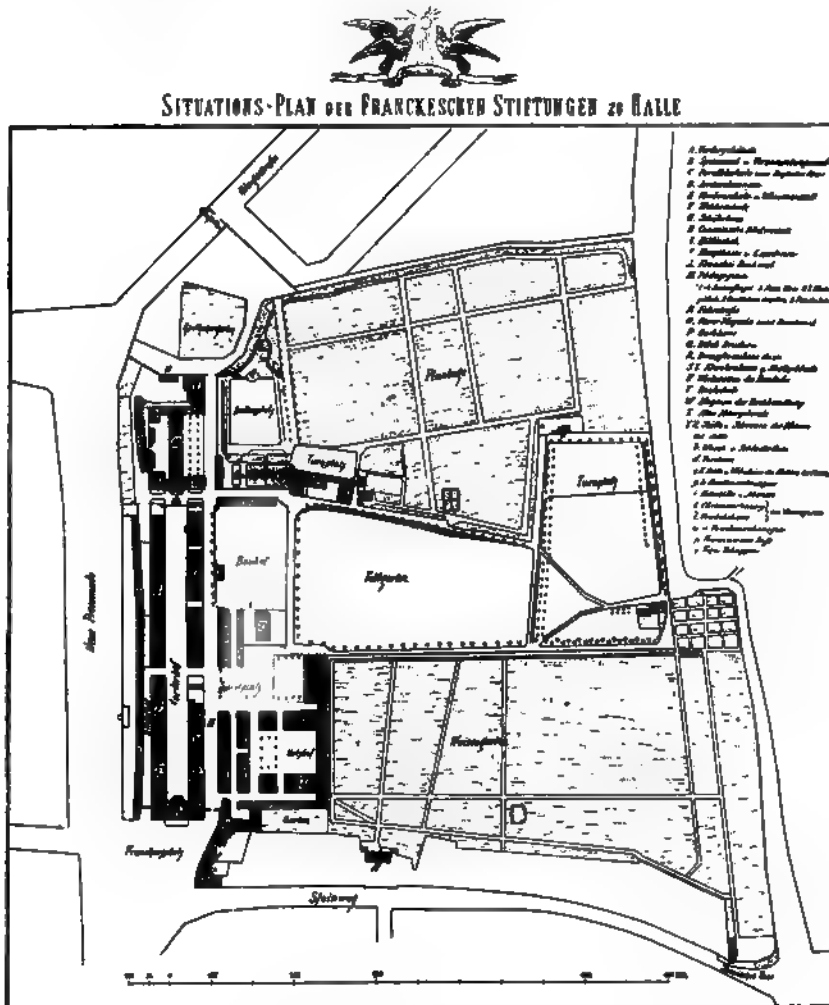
Plan der Francke'schen Stiftungen zu Halle.
